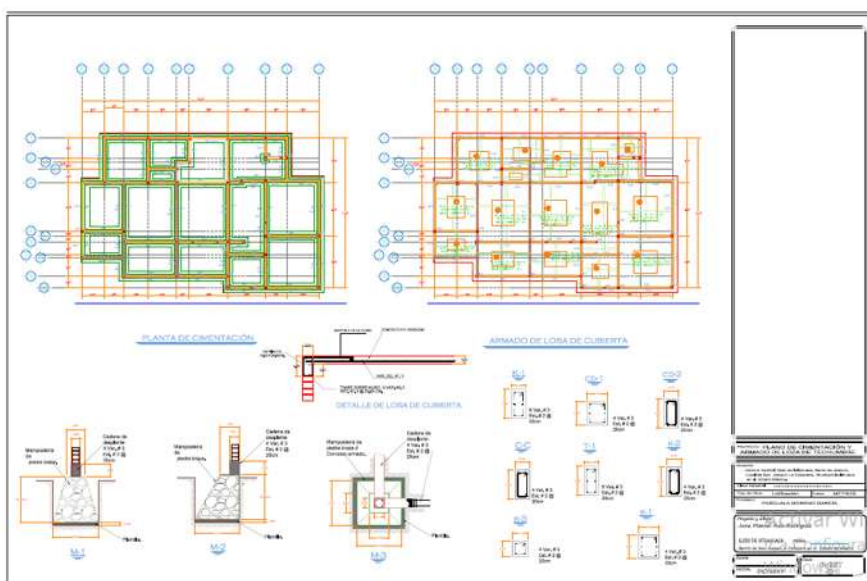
Imagen resultante la propuesta de cimentación y armado de losa, así como el tipo de cimentación central y colindancias, armado de dalas de desplante y columnas y castillo, con su respectivo, detalle de losa de cubierta. En 90x90 cm., en formato dwg. Software AutoCAD. De la C. Pascuala Moreno García en el Municipio de Ixtlahuaca.
